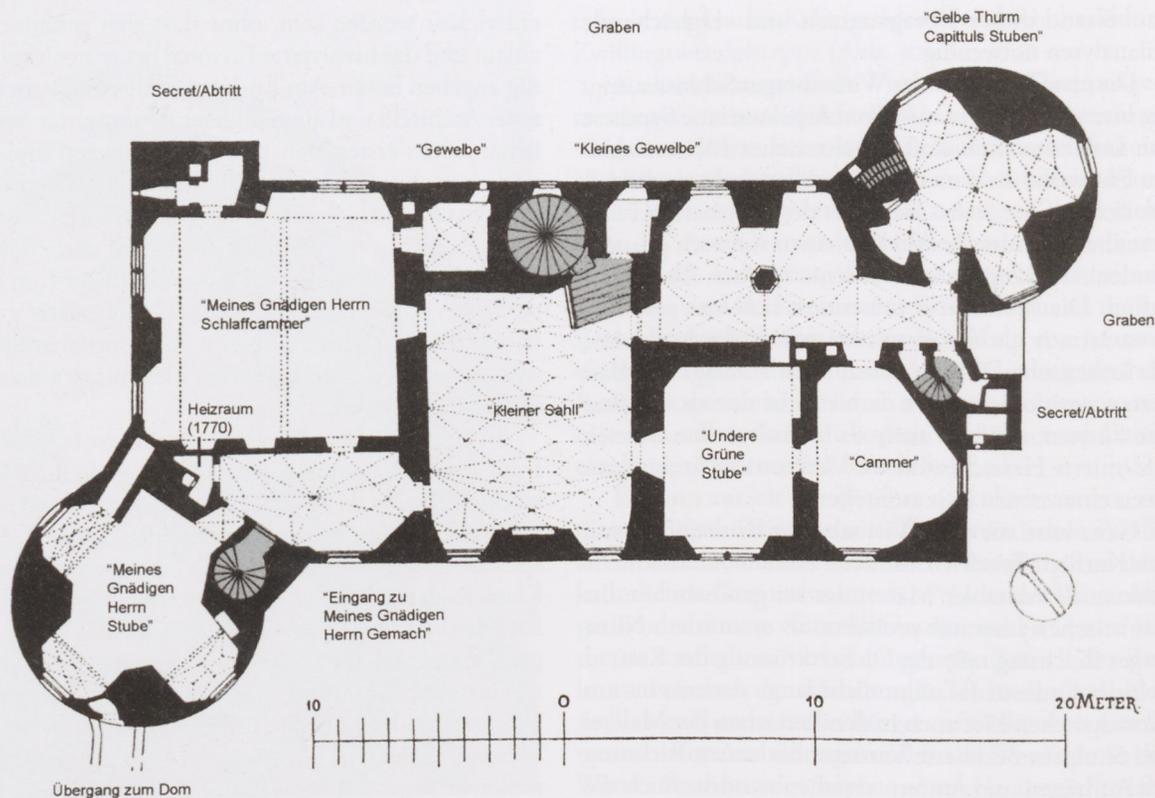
Wurzen, Bischofsschloss, Grundriss des ersten Obergeschosses mit der bischöflichen Wohnung auf der linken (östlichen) Seite, Klaus Kirchner zugeschrieben, ab 1491
